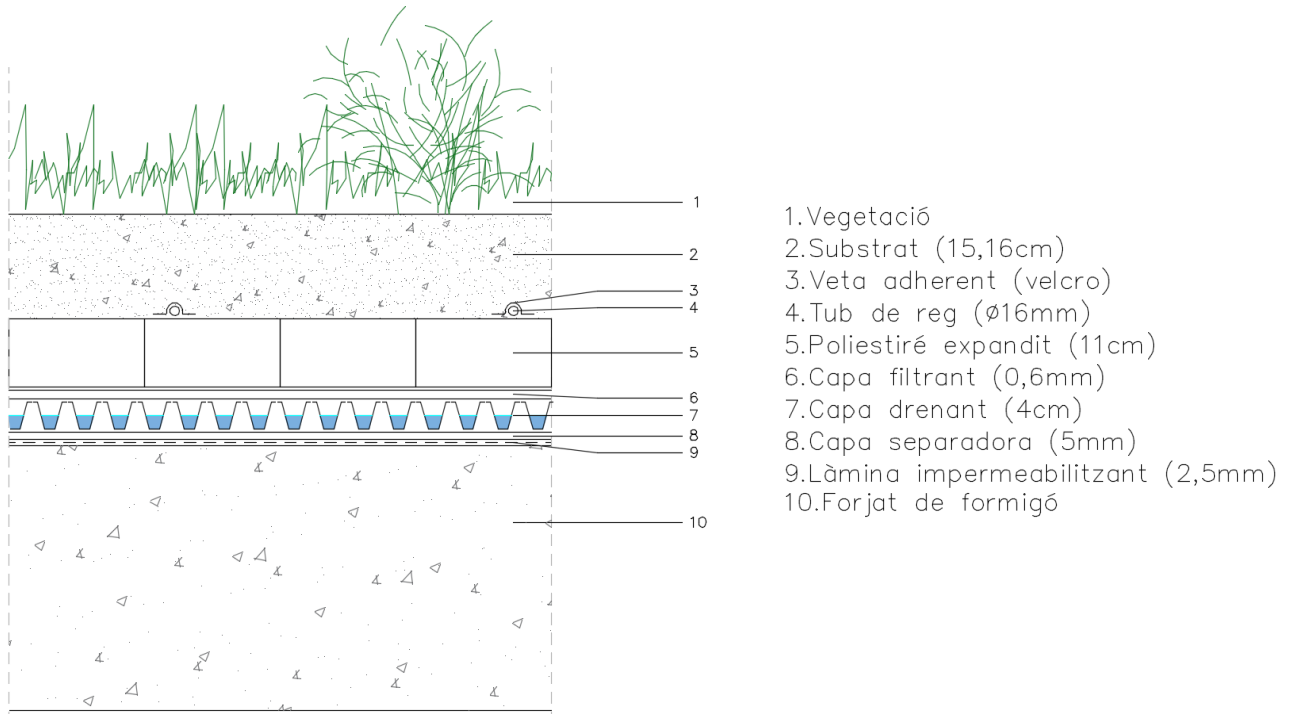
Secció constructiva sistema proposat amb poliestirè expandit.
